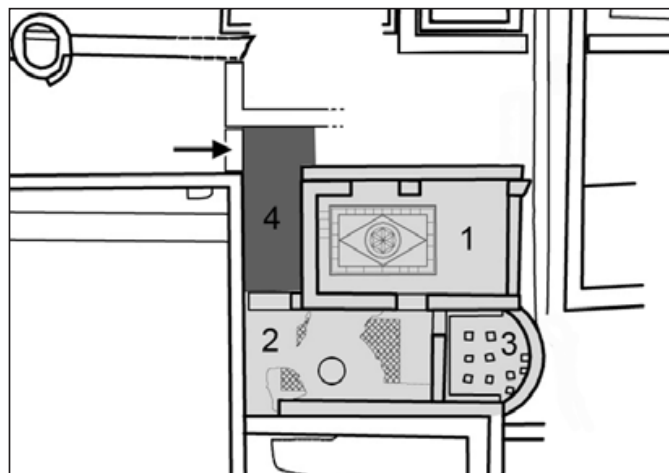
Pianta di dettaglio dell'impianto termale.
